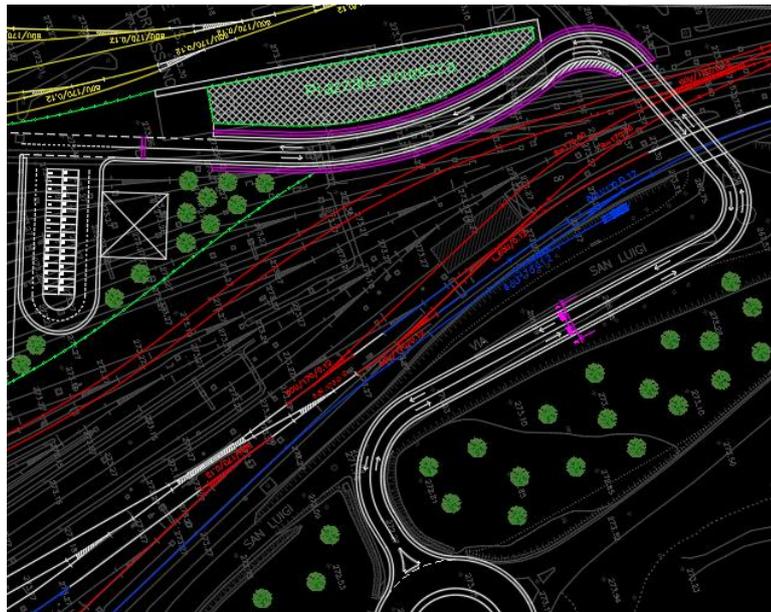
Estratto Autocad, strada di accesso al terminal gateway
